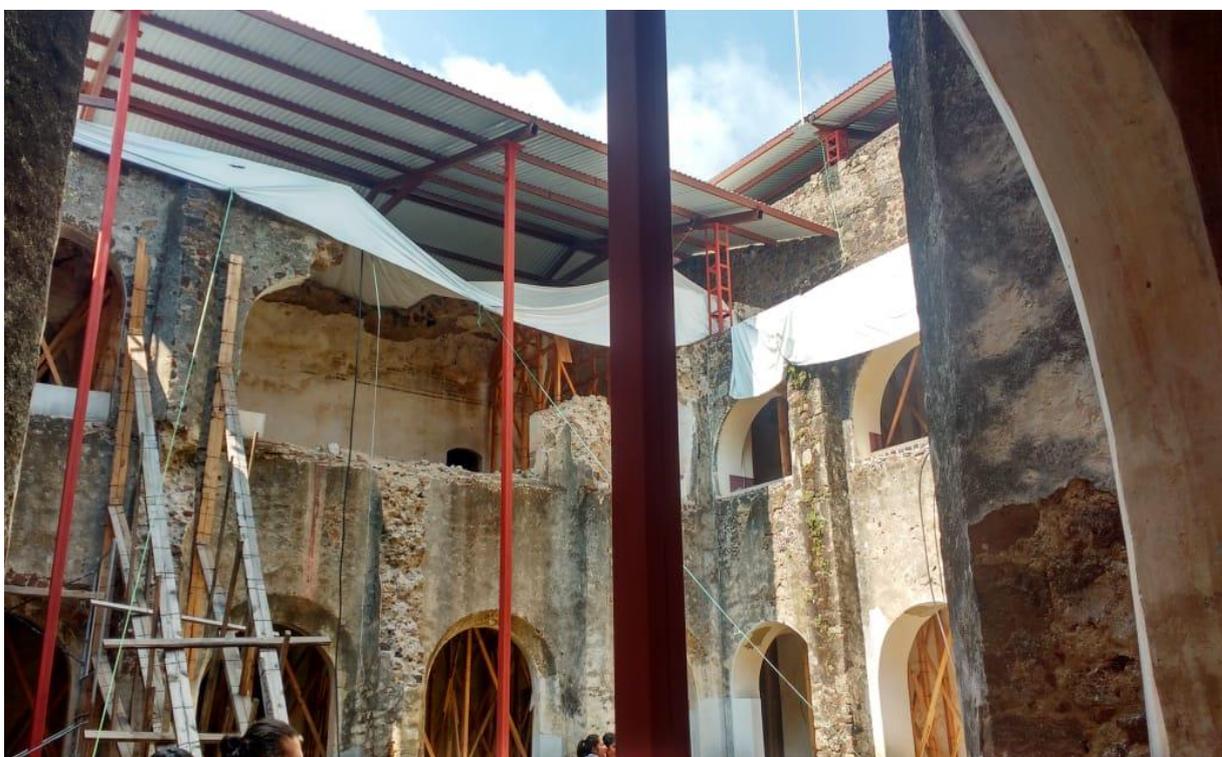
Láminas para protección en fachadas poniente y norte del claustro, 2018. Foto. Laura Moyers Ruíz.
